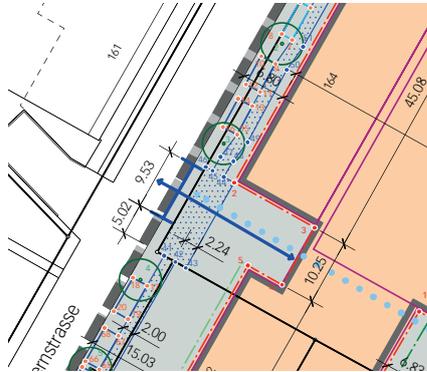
Bereich für die Hauptzufahrt ab der Bernstrasse (blau) mit bestehender Einstellhallenrampe (dunkelgrau)
